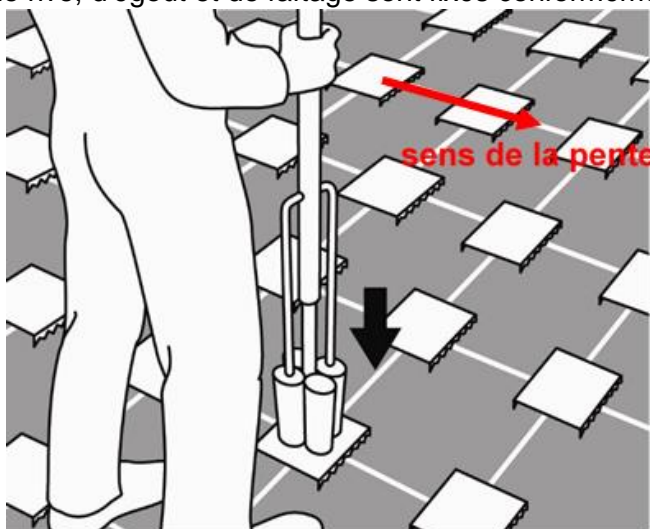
Encastrement des plaquettes crantées dans le FOAMGLAS® surfacé
